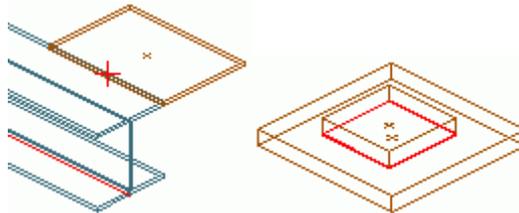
Schweißnahtpunkt, Schweißnahtlinie
